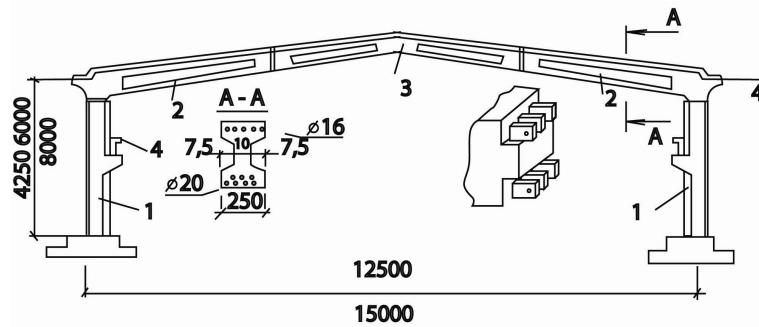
Схема каркасу промислової споруди з двошарнірними збірними складеними рамами /ФРН/ 1 - стійки, 2 – крайні елементи ригеля, 3 – середній елемент ригеля, 4 – підкранові балки
